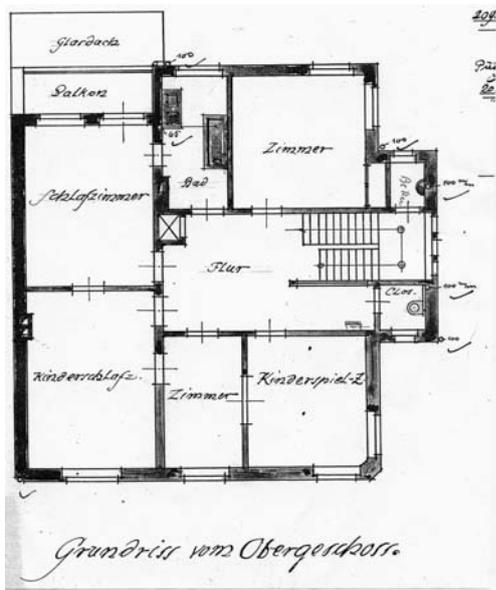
, H. Plange, Haus Clarfeld, Grundriss Obergeschoss, 1914
